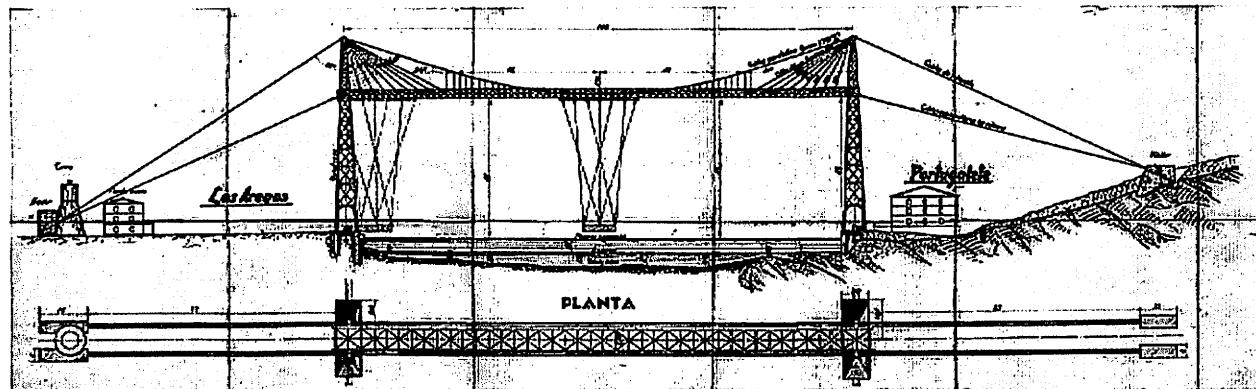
ビスカヤ橋の側面図（下流側より）と平面図
